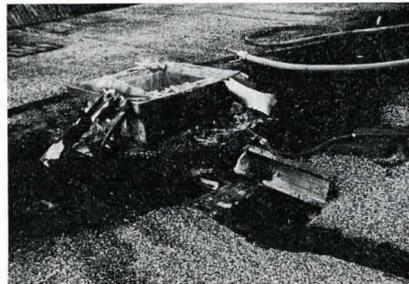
Rückstauende Entlüftungsventilatoren mit Kunststoffflügeln.
